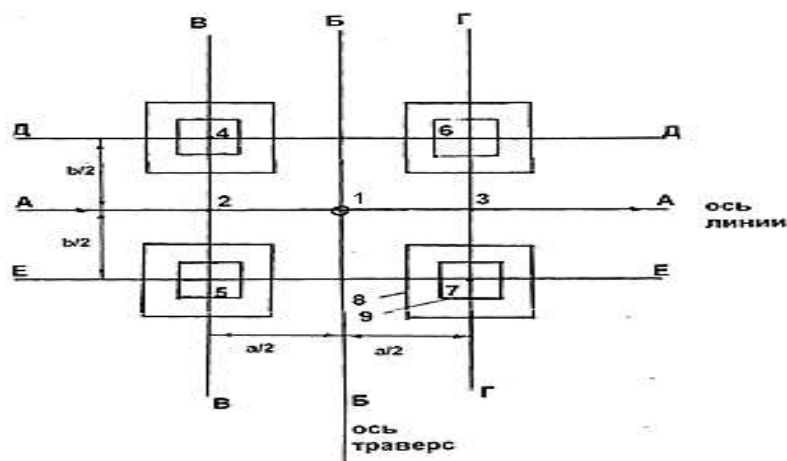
Схема разбивки котлованов для установки анкерно-угловых одно- и двухстоечных железобетонных или деревянных опор
